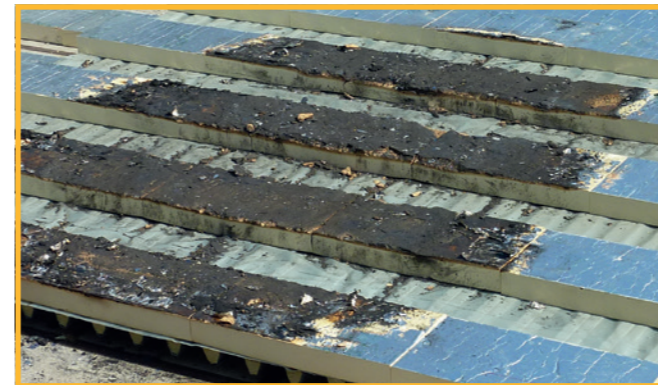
| PU-Dach – Dampfsperre unbeschädigt
